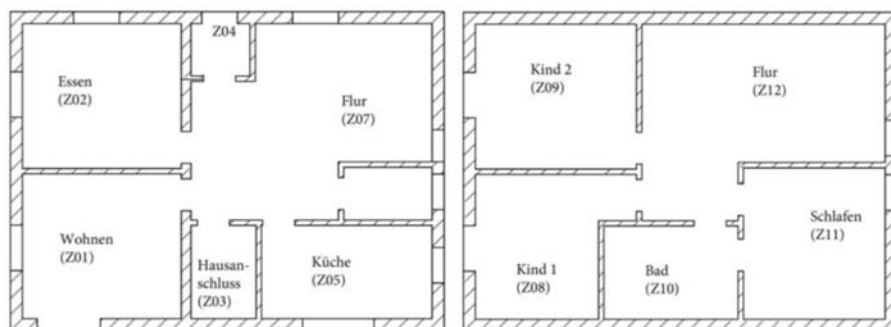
Grundriss Erdgeschoss (links) und Obergeschoss (rechts)
